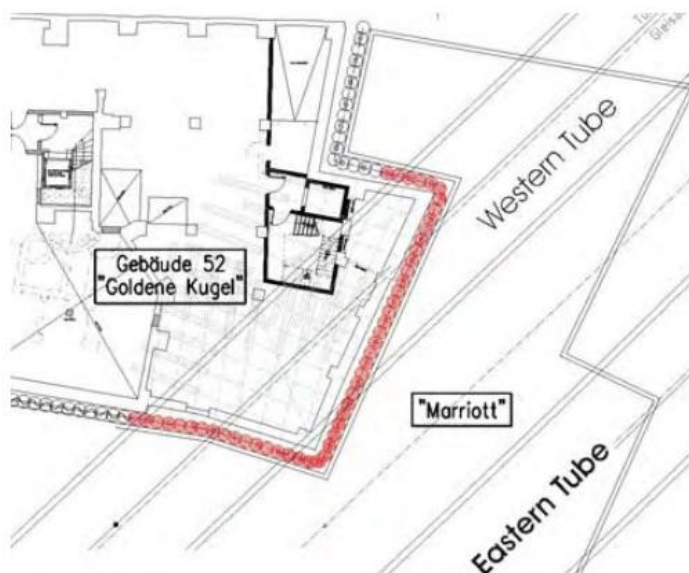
Planta com intersecção túnel - parede (vermelho: parede de estacas demolida) (Fonte: KIRSCH et al., 2009)
